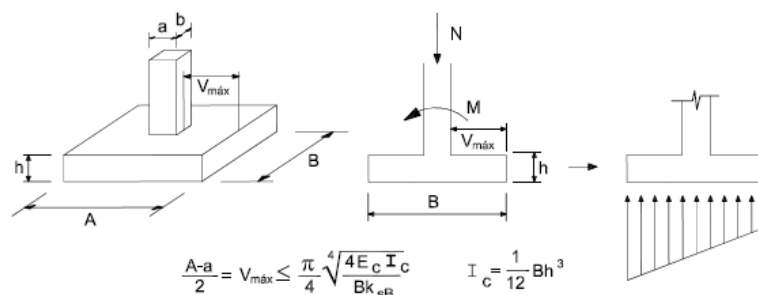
Modelo de cálculo para zapatas aisladas. CTE [17].
